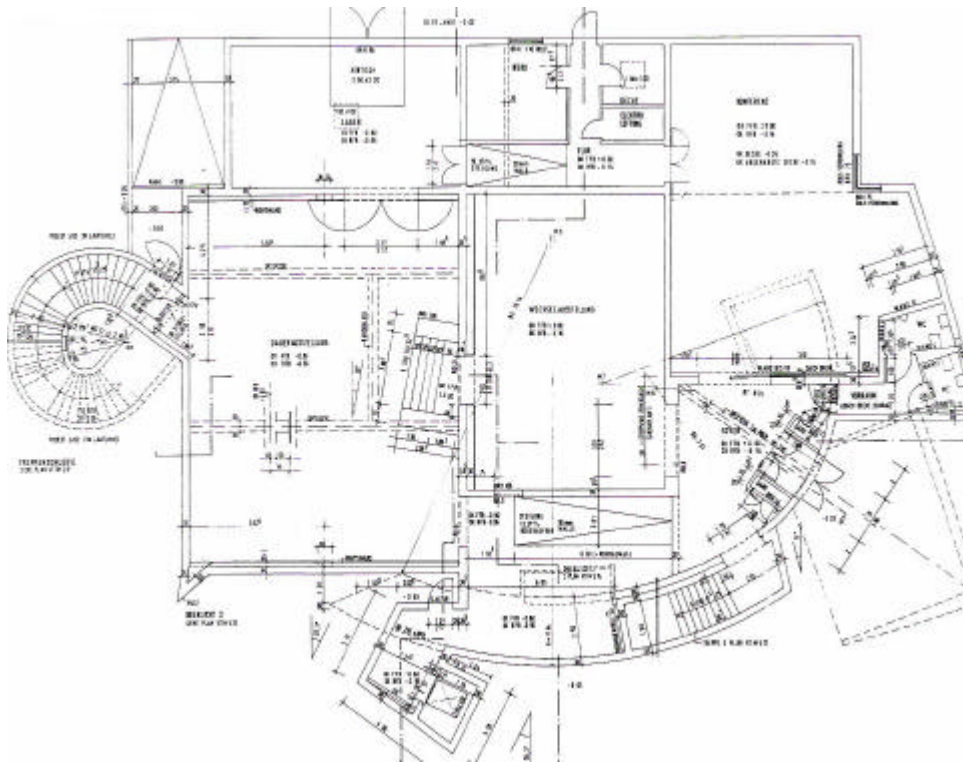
Frank Gehry, Vitra Design-Museum, 1987-1989, Grundriß Erdgeschoß
